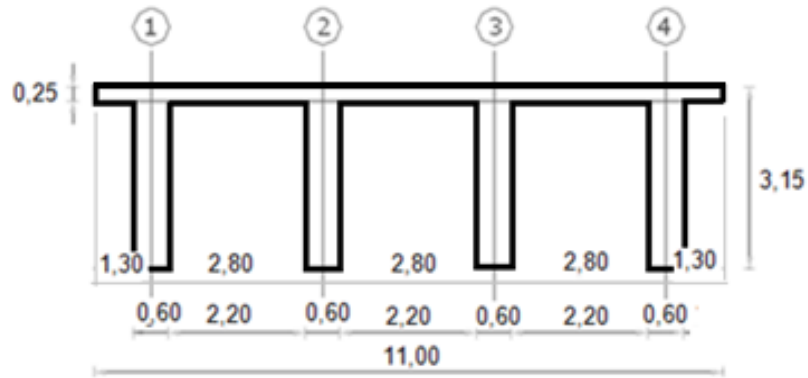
Encofrado para vigas y tablero en los extremos del vano
